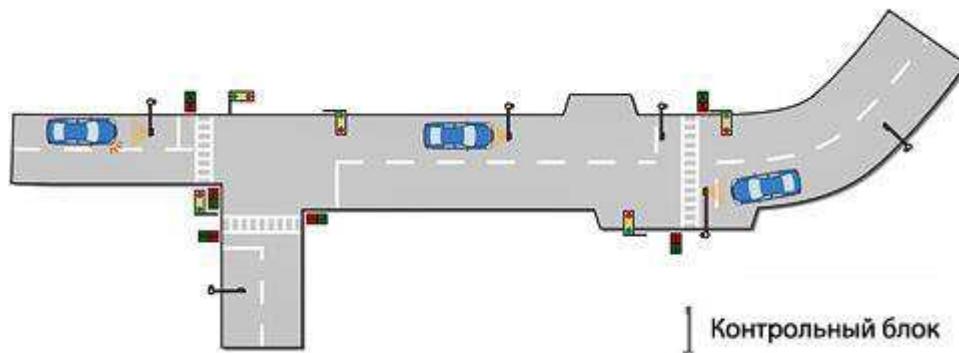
Схема перекрестка оборудованного ИТС
